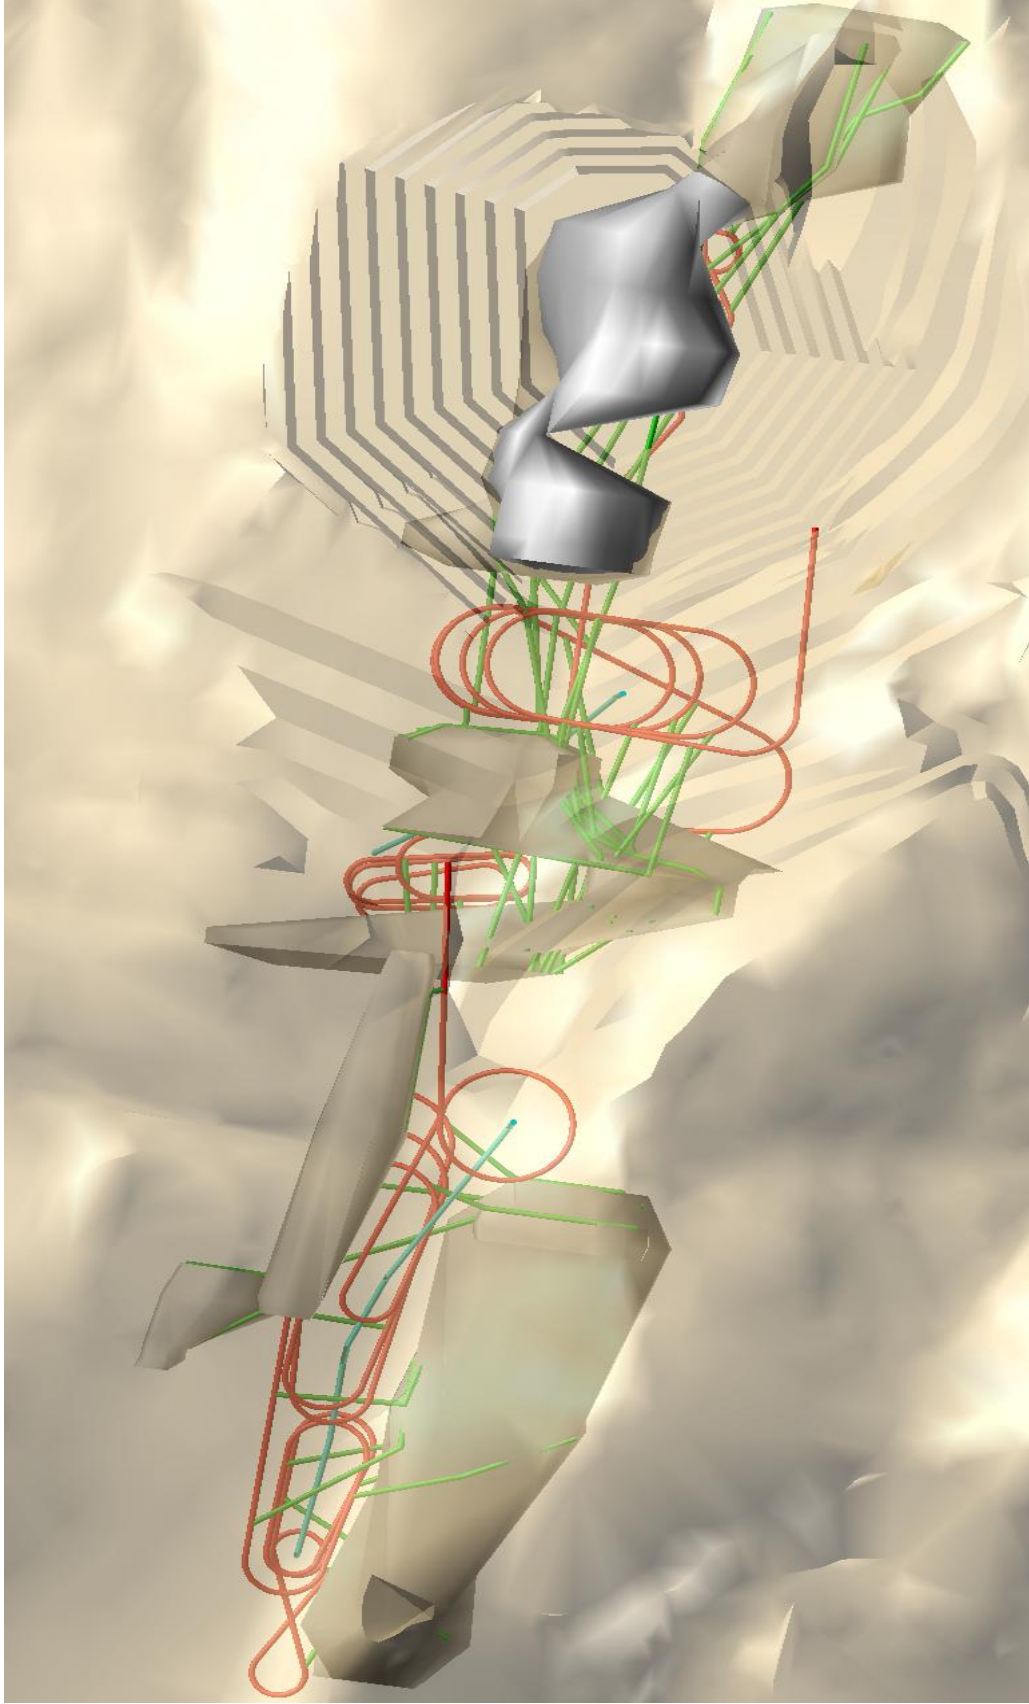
Yeraltı dizaynı plan görüntüsü
